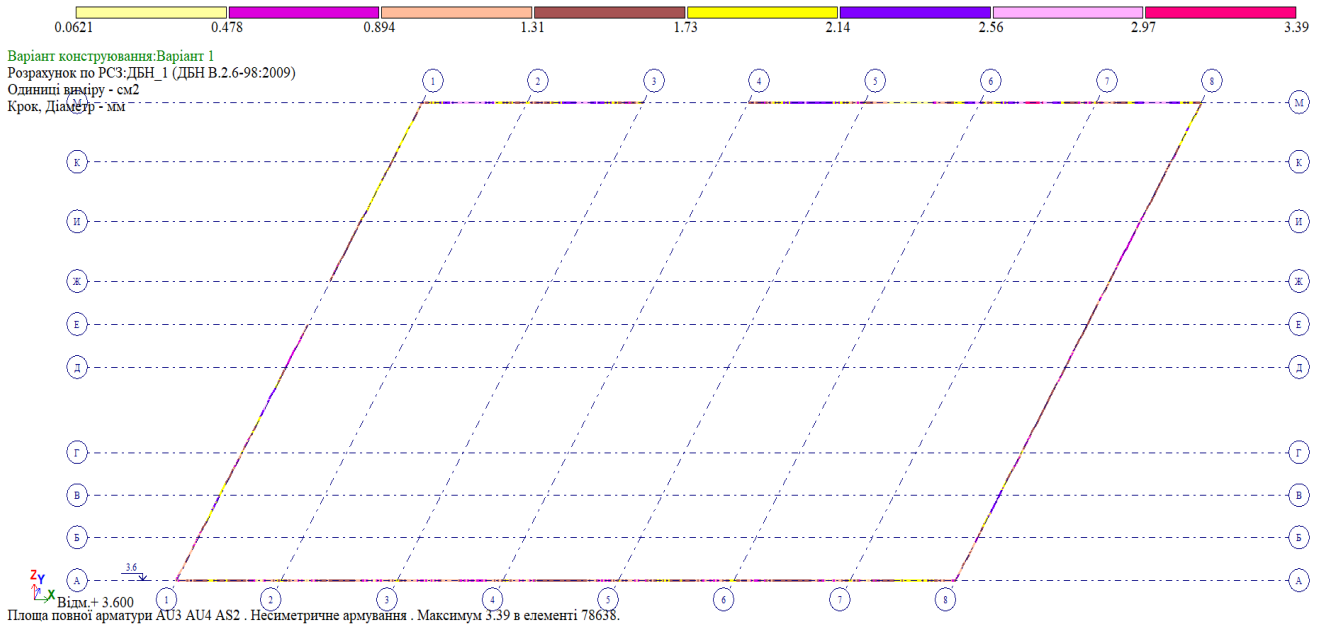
Площа робочої арматури у верхній грані балки Б-1
